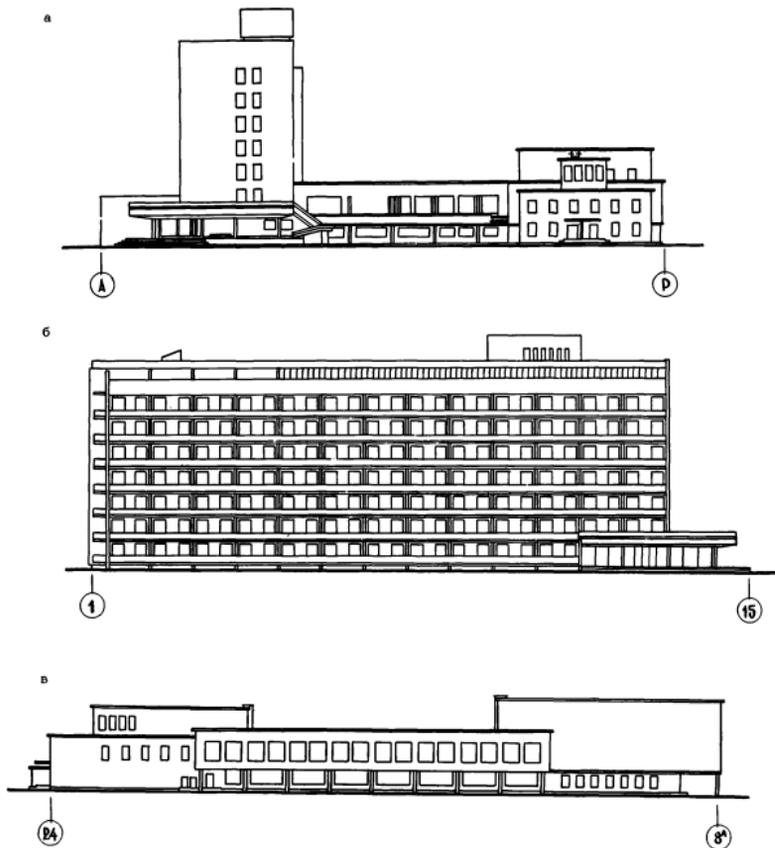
Фасады: а - фасад А-Р; б, - фасад 1-15; в - фасад 24-8а
